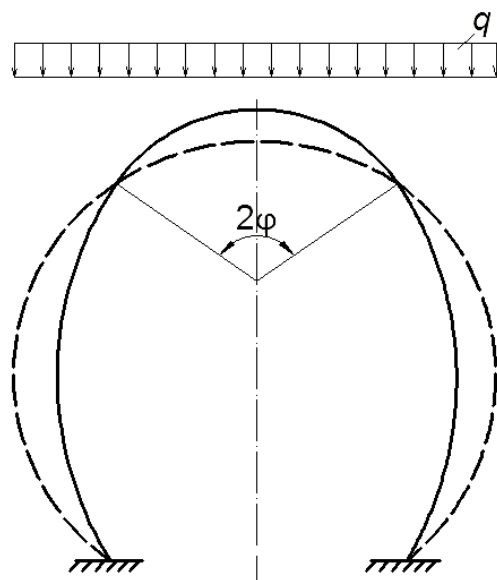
Общая схема деформирования тоннельной обделки в упругой среде грунта
